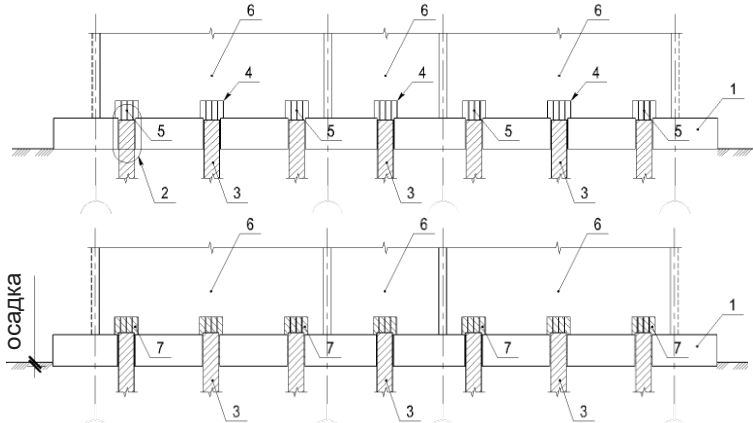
Способ возведения свайно-плитного фундамента: 1 – плита-ростерк; 2 – сквозное отверстие в плите; 3 – проектные сваи; 4 – ниши над головами свай в несущих стенах; 5 – арматурные выпуски свай для формирования жестких узлов; 6 – несущие стены; 7 – бетон для заполнения ниш в стенах при достижении заданной величины осадки плиты (патент РФ № 2513050)
